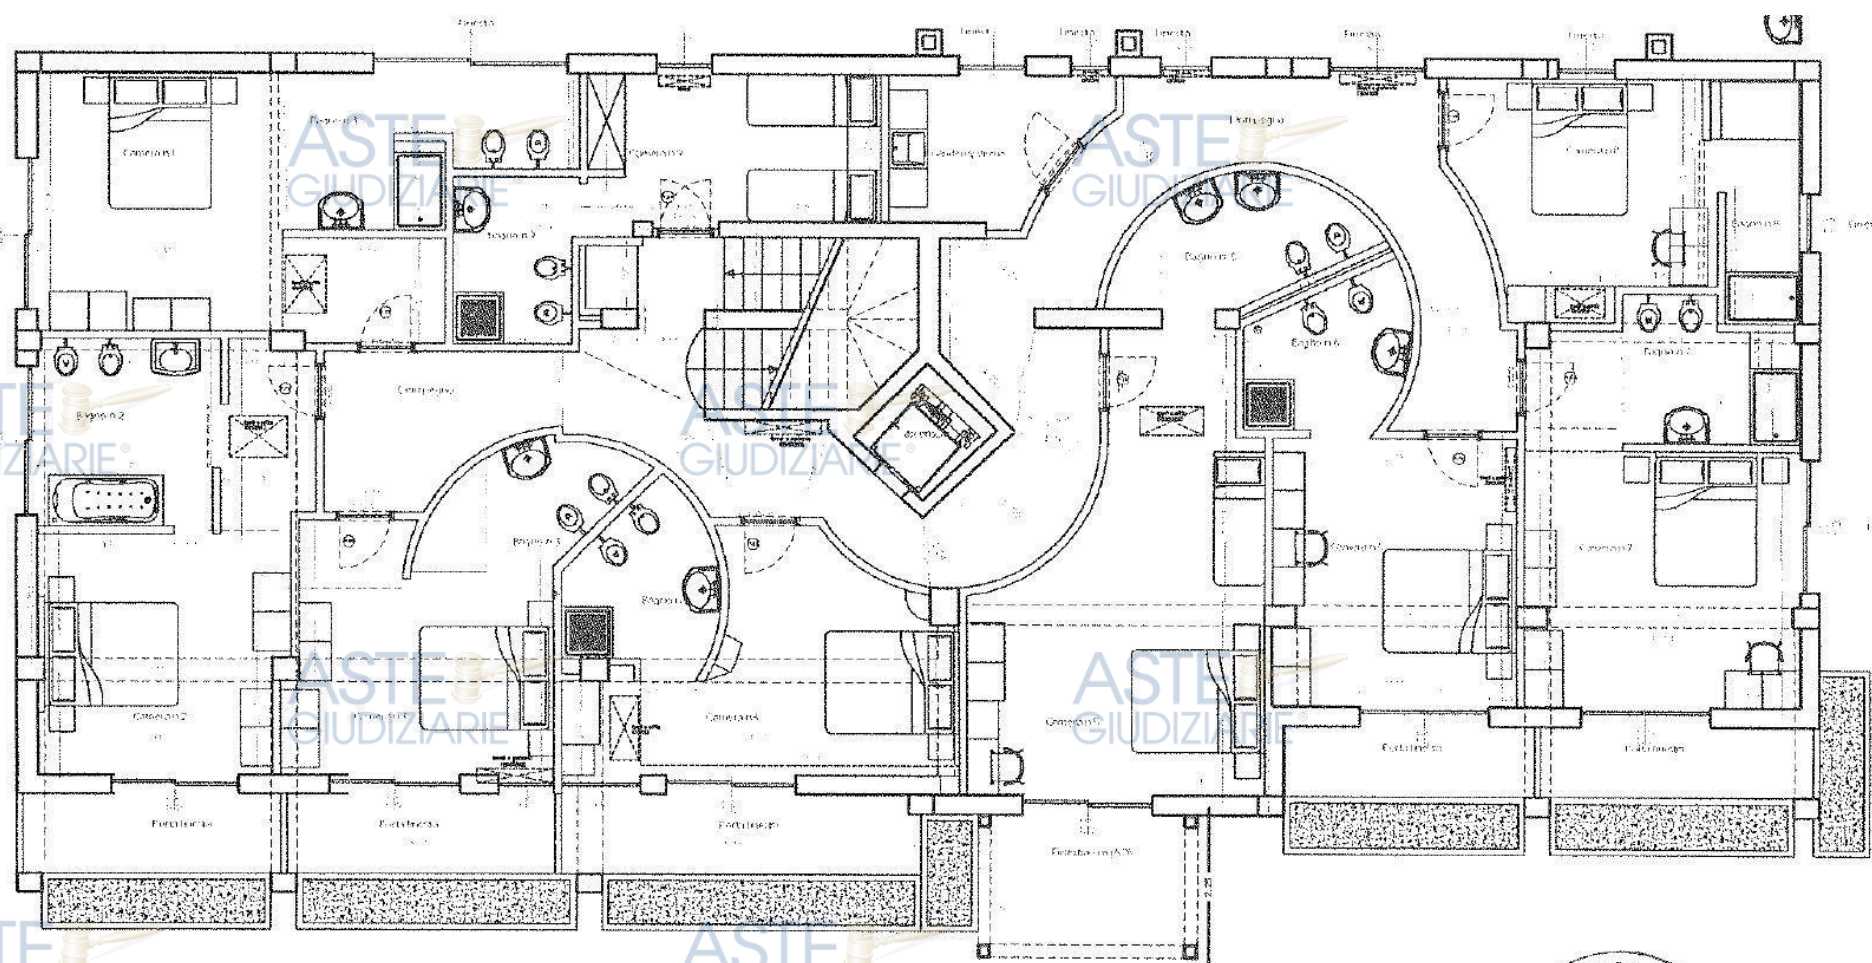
Stralci pianta piano primo – Grafici di D.I.A. prot. 10231 del 18/01/2007
